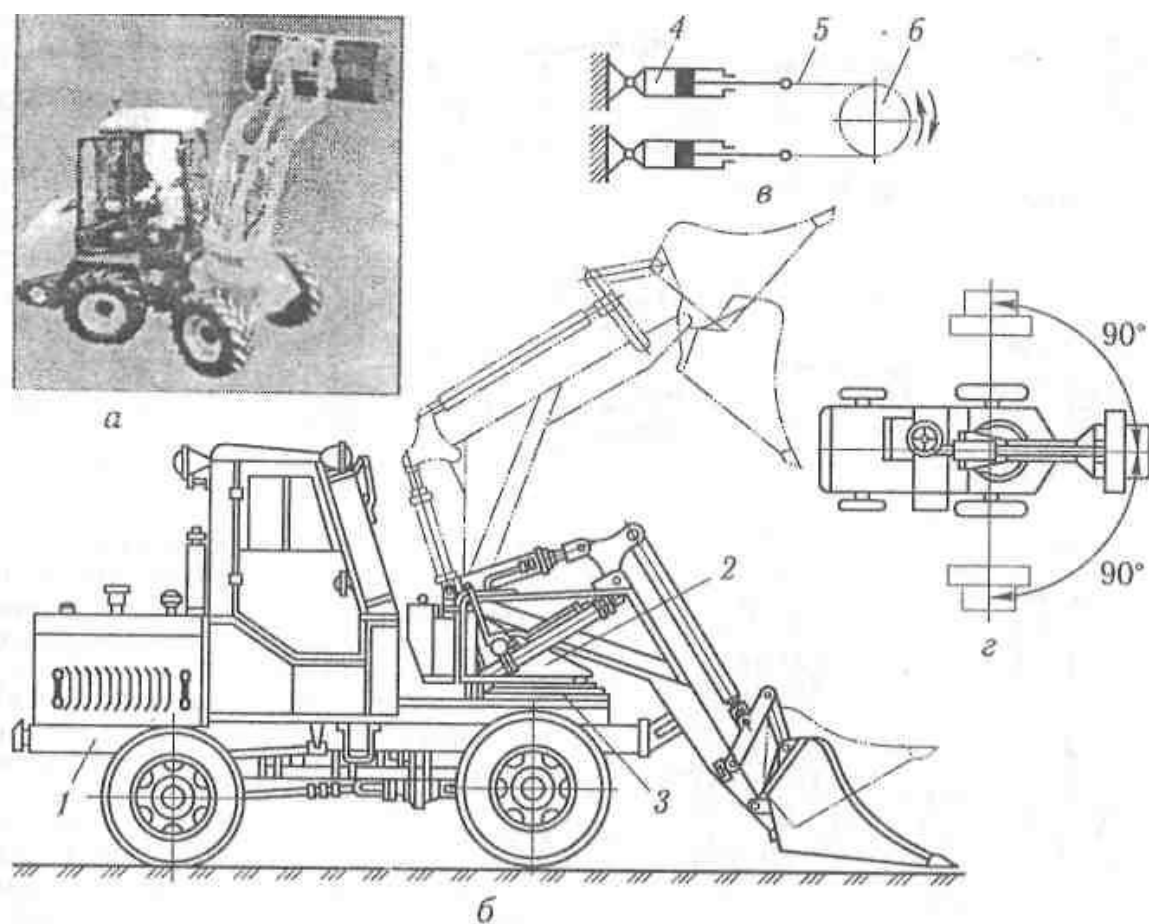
Одноківшевий напівповоротний навантажувач: а – загальний вигляд; б – конструктивна схема; в – схема системи повороту; г – зона дії; 1 – рама; 2 – опорно-поворотний пристрій; 3 – поворотна платформа; 4 – гідроциліндр; 5 – ланцюг; 6 – зірочка
